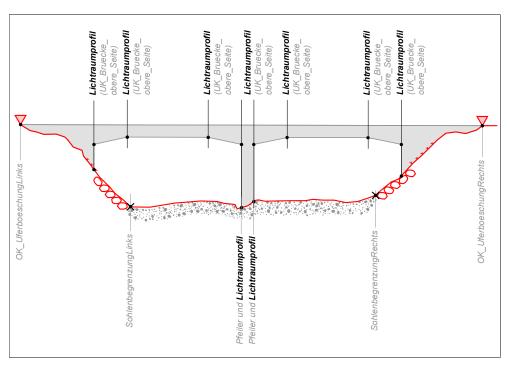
Profil d'espace libre dans le cas d'un pont à piles
